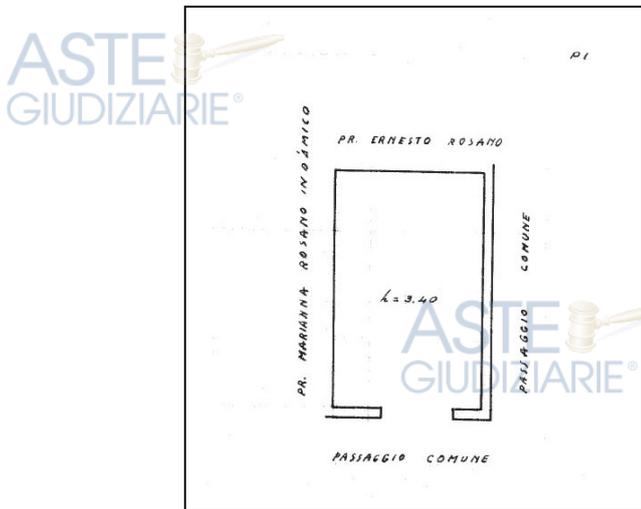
Estratto planimetria catastale del 03/05/1957. Magazzino sub. 3
